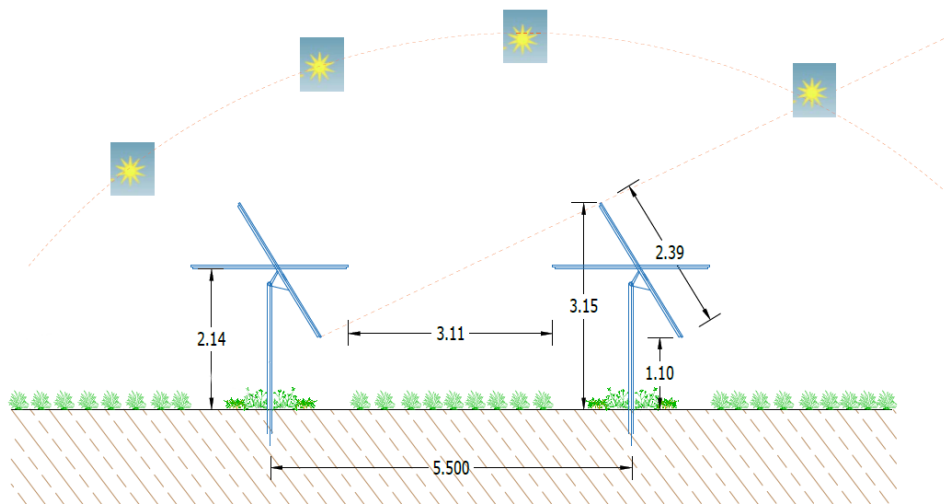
Sezione lotto d'impianto con tracker 1V30 e 1V15
